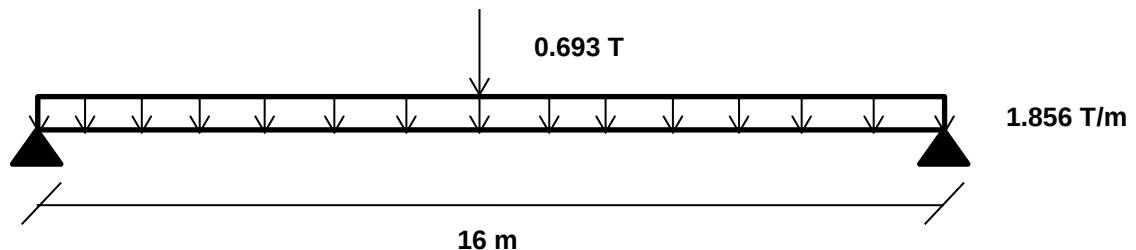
Esquema simplificado de la viga interior longitudinal apoyada sobre los estribos,, con la carga muerta que actúa en ella.
